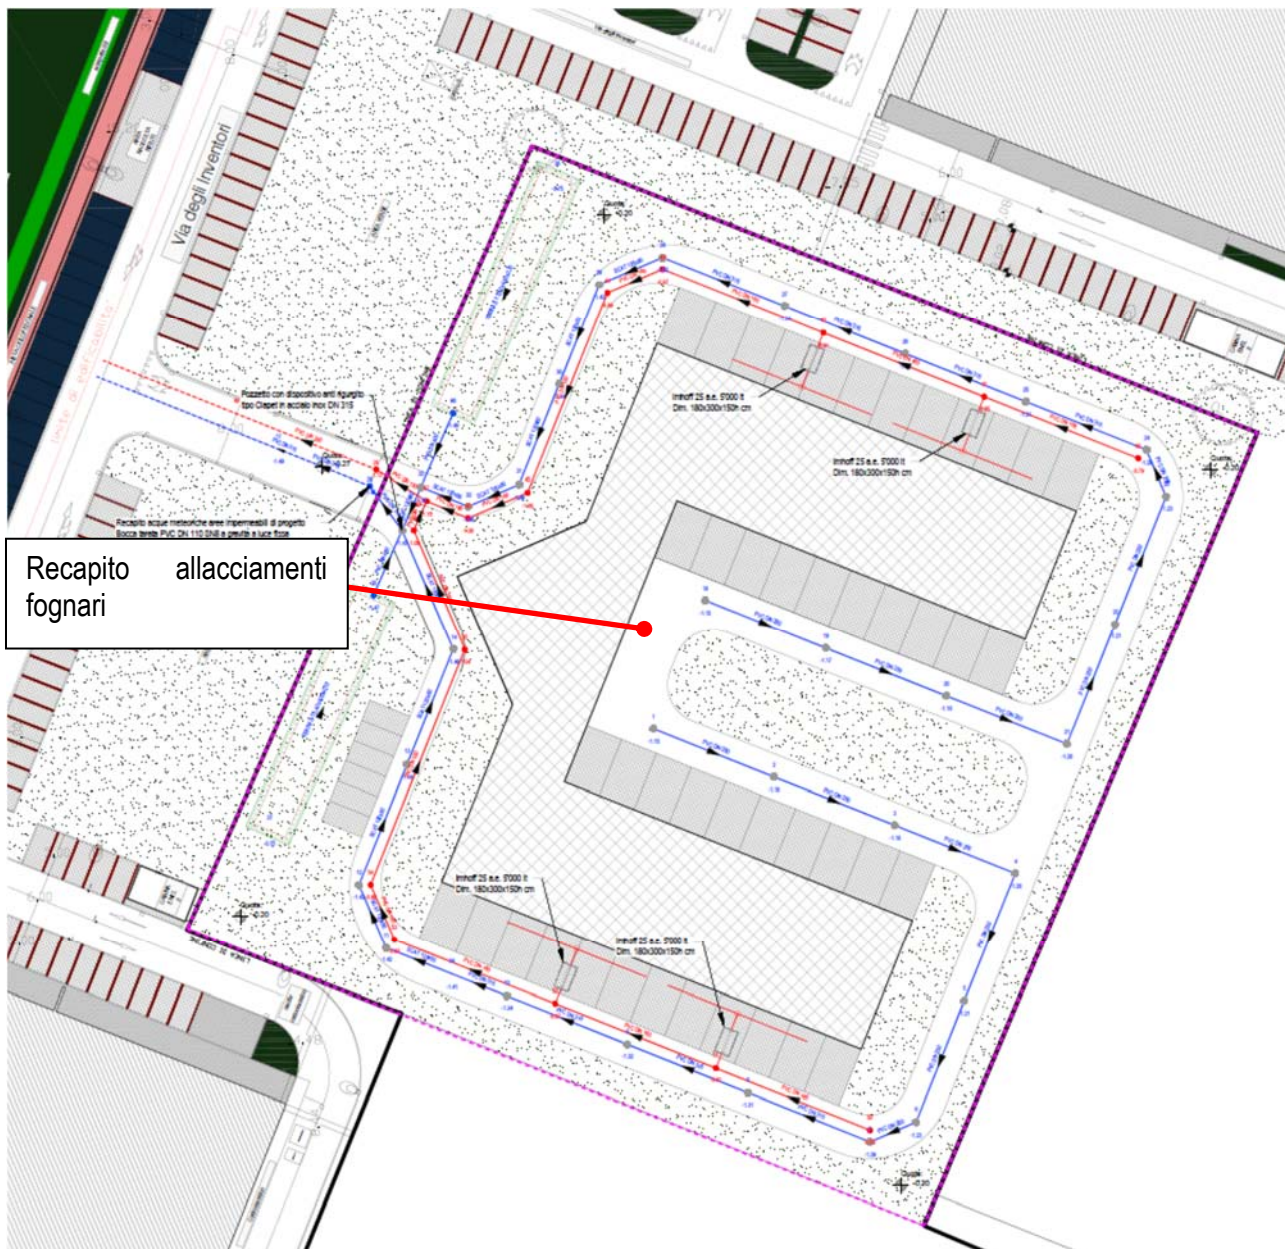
Planimetria generale della rete di allacciamenti fognari interna al lotto.
